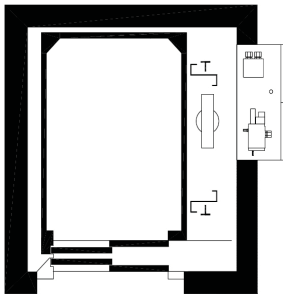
Seilhydraulischer Aufzug – Grundriss (Grundlage für Berechnungsbeispiel)
